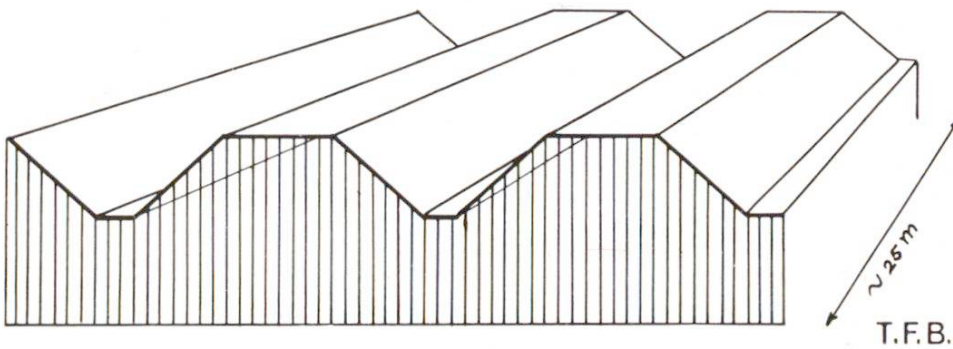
Überdachung mit Betonschale in prismatischer Form ohne Säulen und besondere Verstärkungsrippen. (Concrete and Constructional Engineering, 47, 11, (1952))
